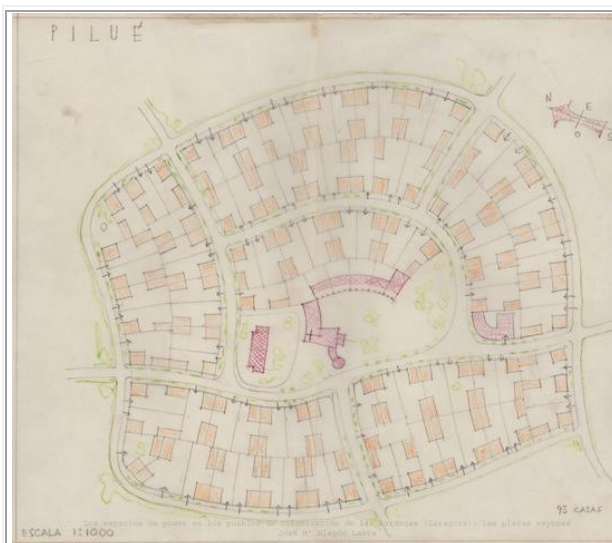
Planta del pueblo de Pilué, por el arquitecto José Borobio, hacia 1953(Fuente: Archivo de la familia Borobio).
